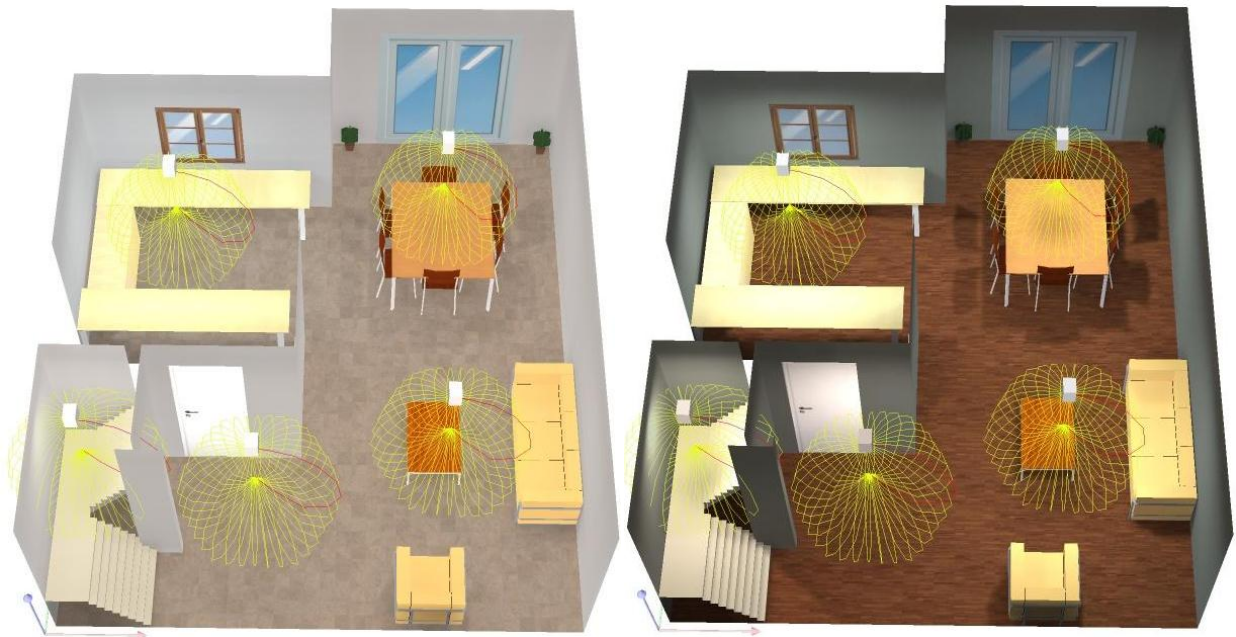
Planta baja: Sala, escalera, comedor y cocina.
